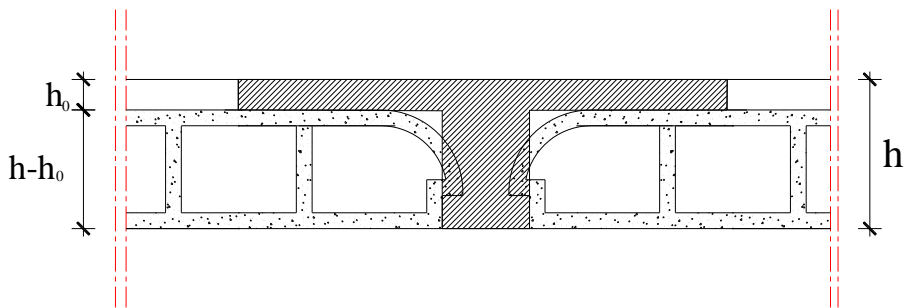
Coupe transversale d'un plancher à corps creux
